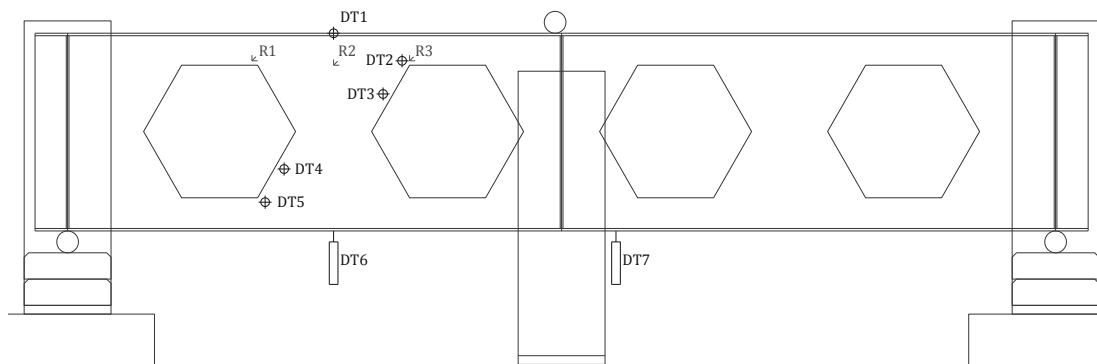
Esquema da montagem e instrumentação dos ensaios.
